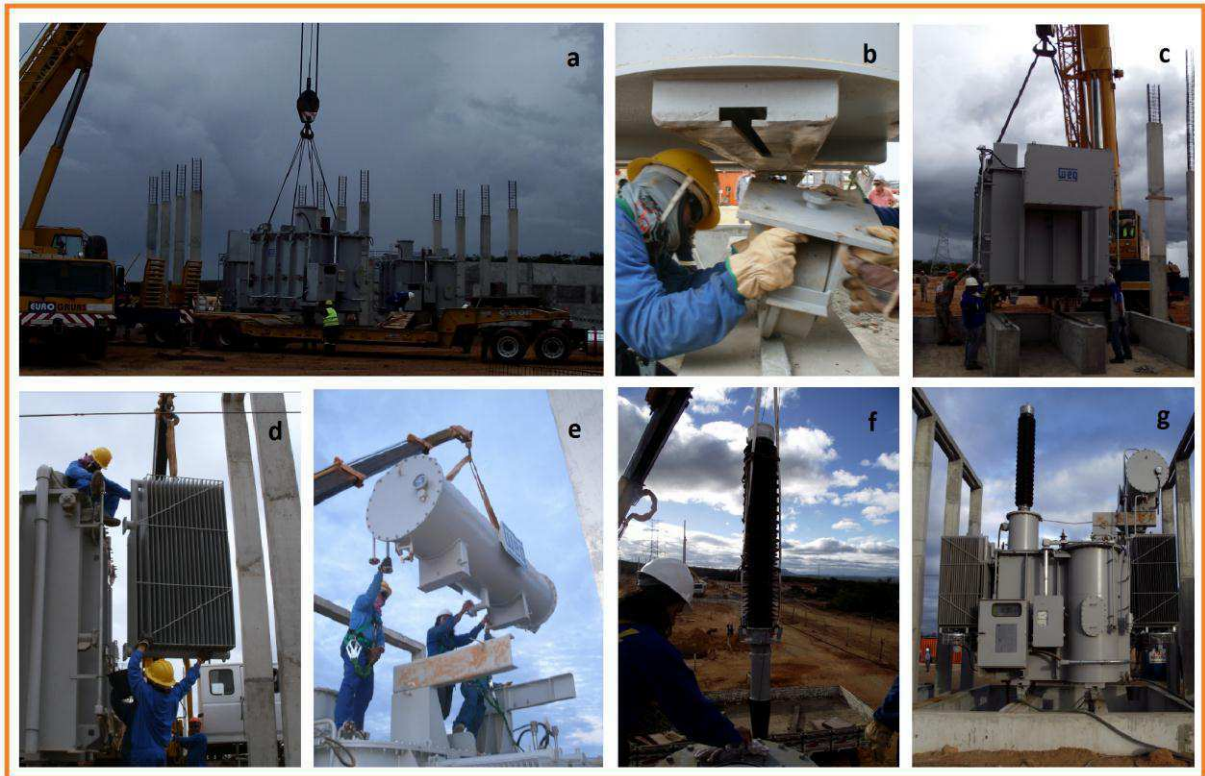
Montagem do Transformador de Força: (a) descarga (b) fixação de rodas (c) instalações sobre a base (d) radiadores (e) tanque de expansão (f) bucha de AT (g) montagem acabada
